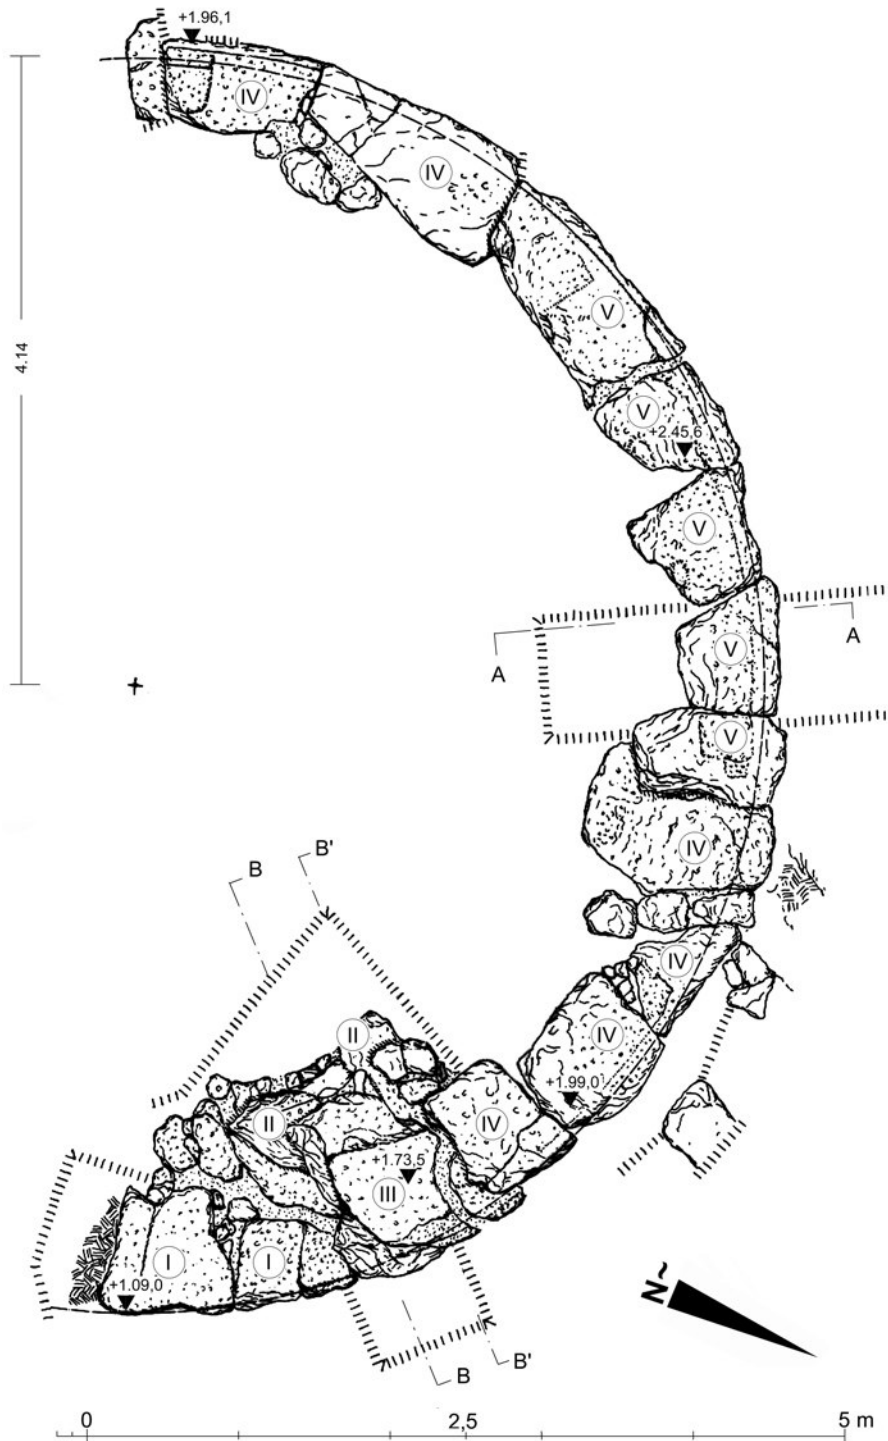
Pyrgos Batidene, Grundriss (M. 1 : 50)
